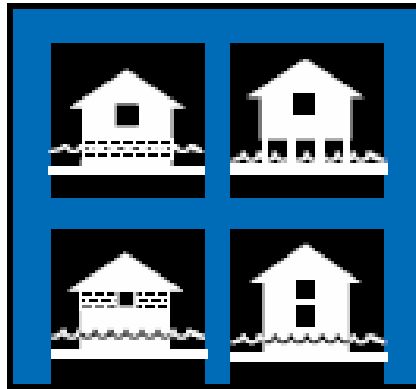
Elevação da edificação (Elevation) (FEMA, 1998).
